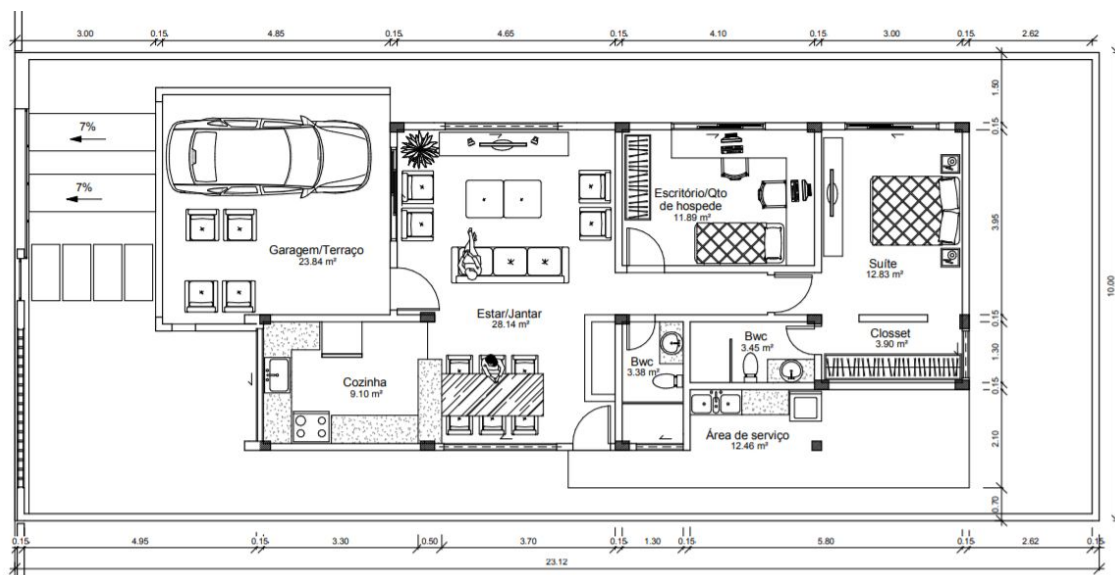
Planta baixa para o desenvolvimento do projeto. Sem escala.
